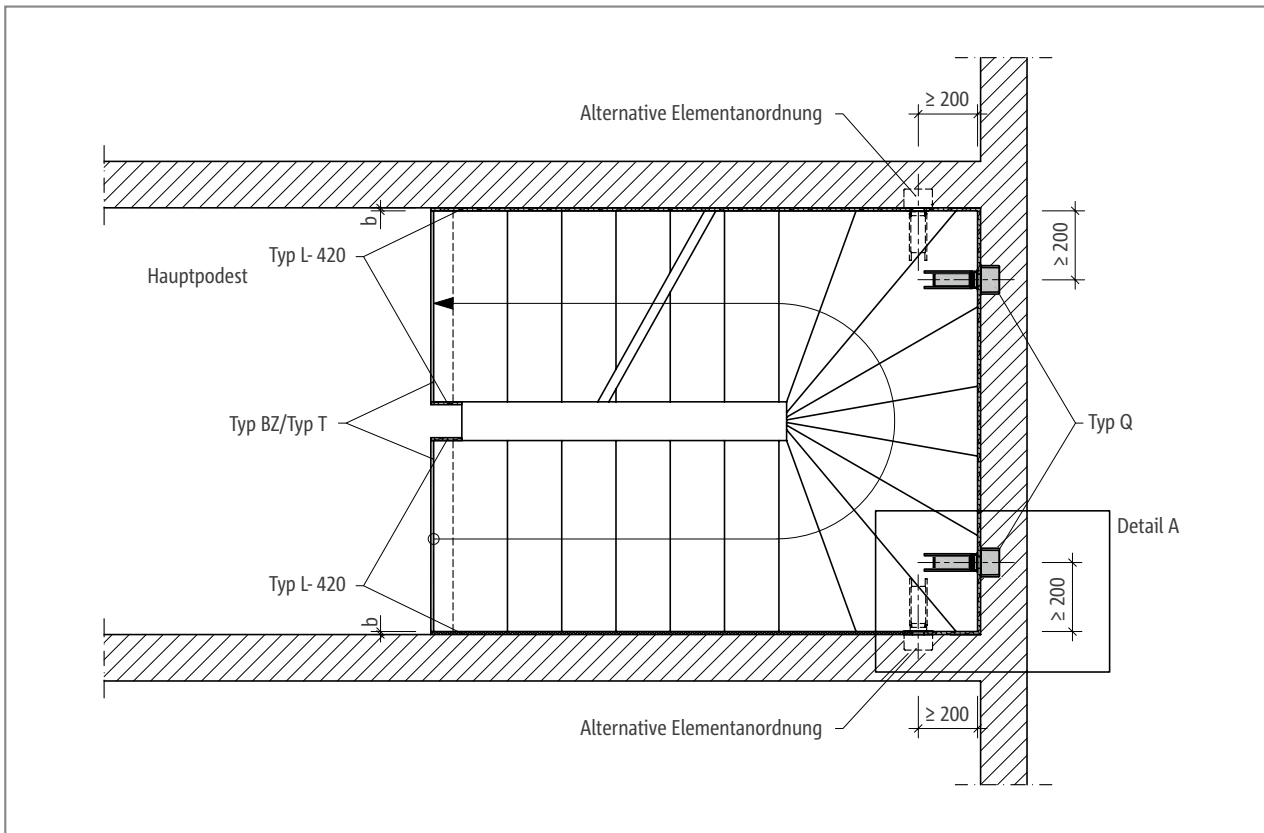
Schöck Tronsole® Typ Q...-XL: Elementanordnung im Grundriss bei einer Fugenbreite von maximal 100 mm
